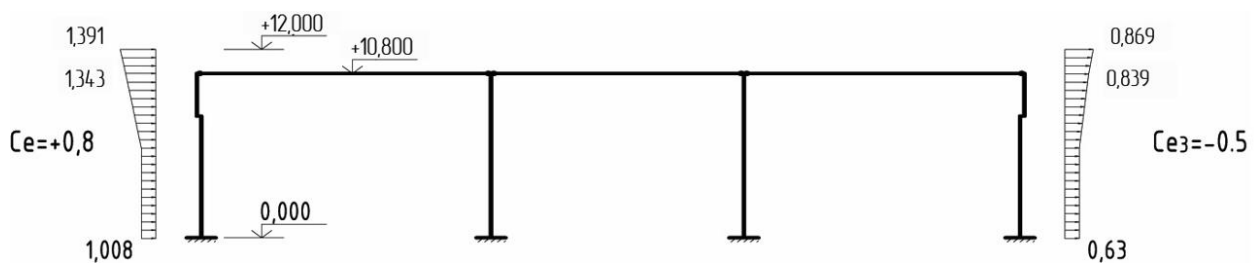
Схема вітрового навантаження на промислову будівлю
